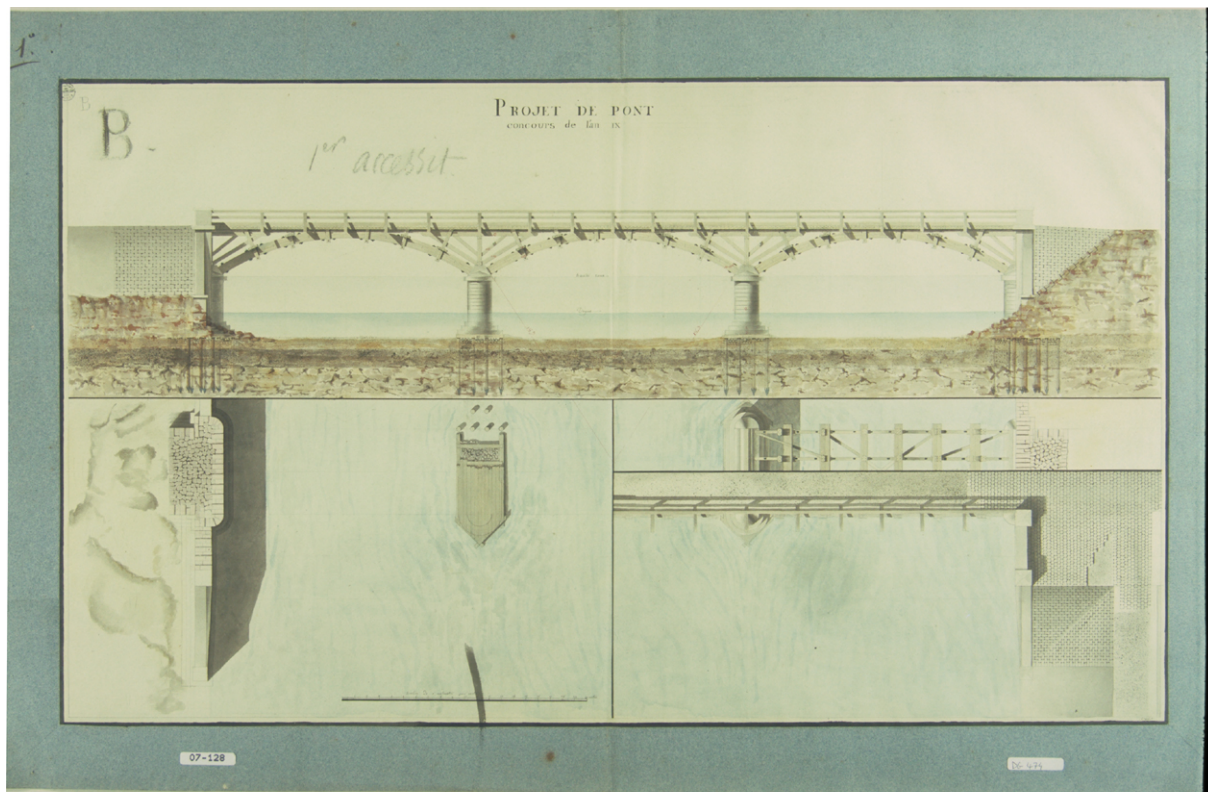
Progetto di un ponte in legno. Prospetto, pianta e particolare.
